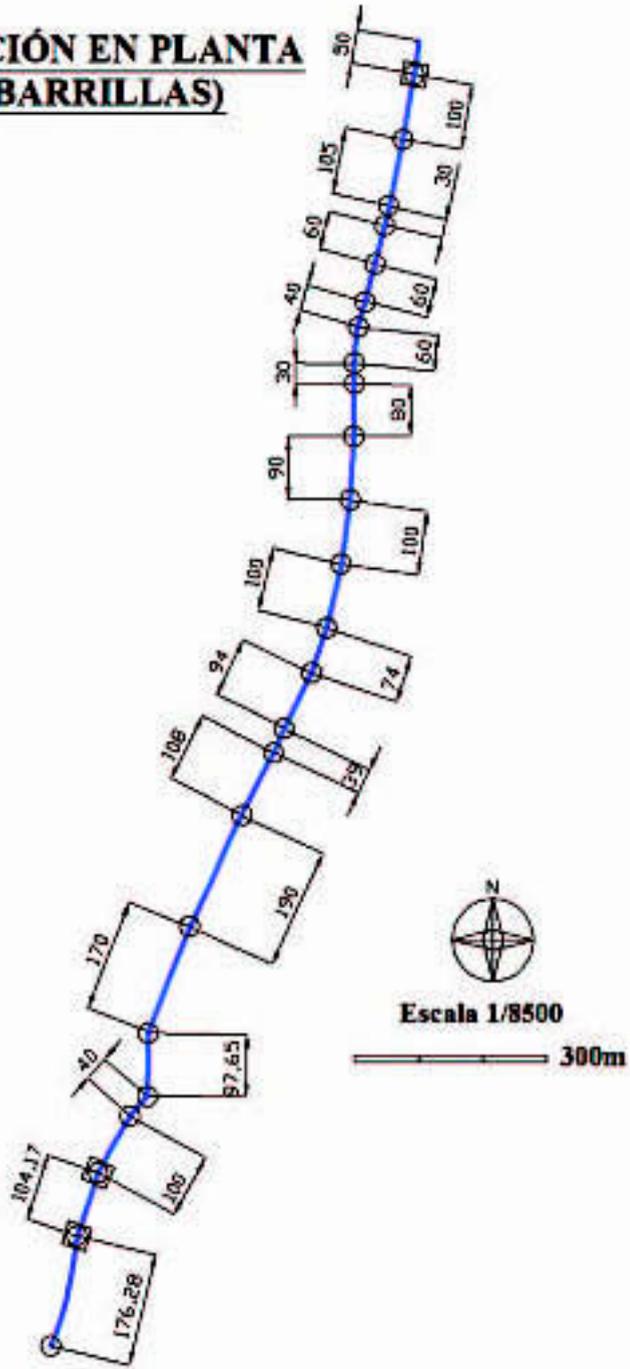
Dibujo (aclaración en metros) del Sistema de galerías con lumbreras encontrado en el paraje de Las Tobarrillas (Yecla).
